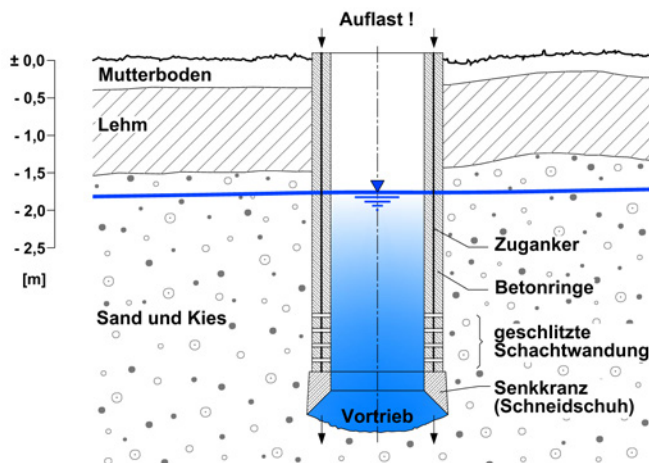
Entwicklung der Brunnenbauformen vom gemauerten zum mit Betonringen ausgesteiften Schachtbrunnen
